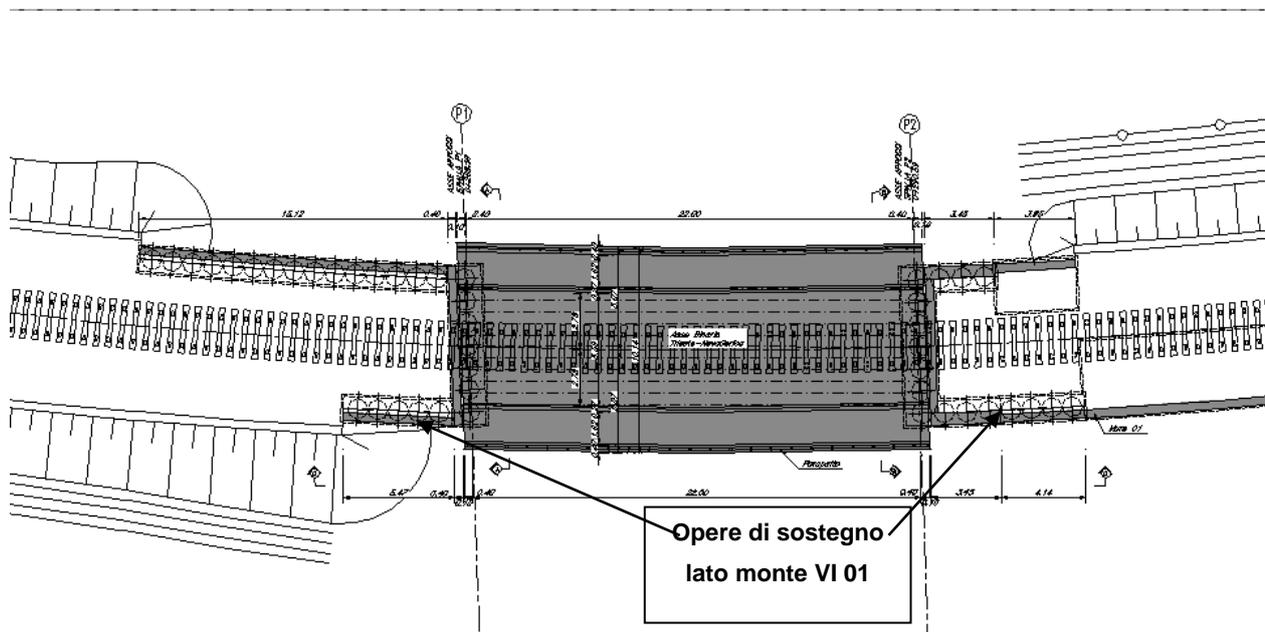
Planimetria con ubicazione dell'opera di sostegno lato monte.
